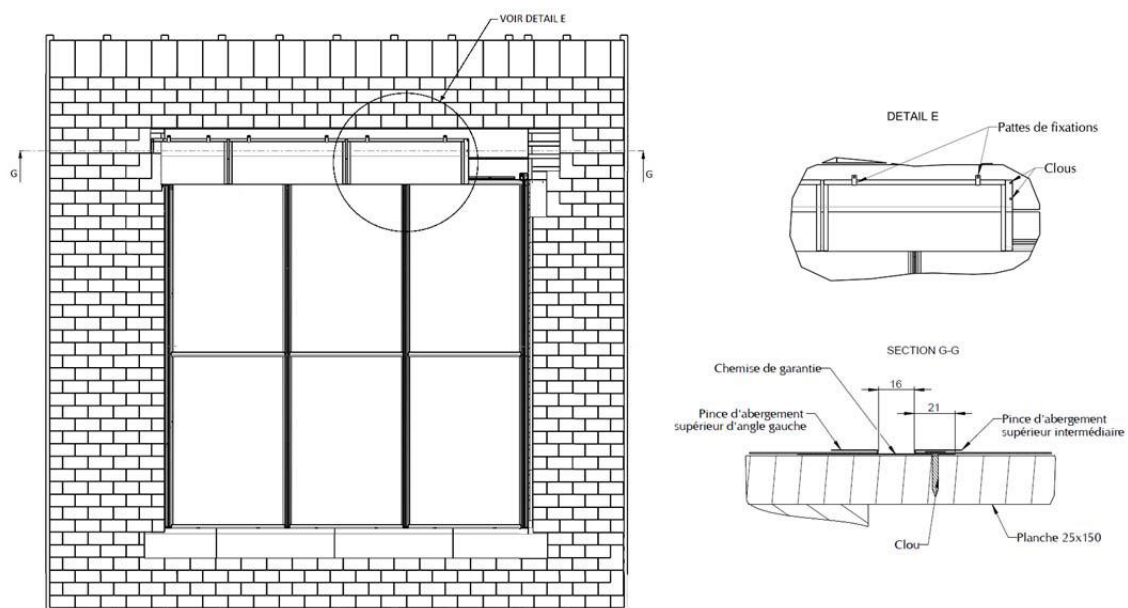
Pose des abergements supérieurs intermédiaires pour installation sur toiture ardoise
